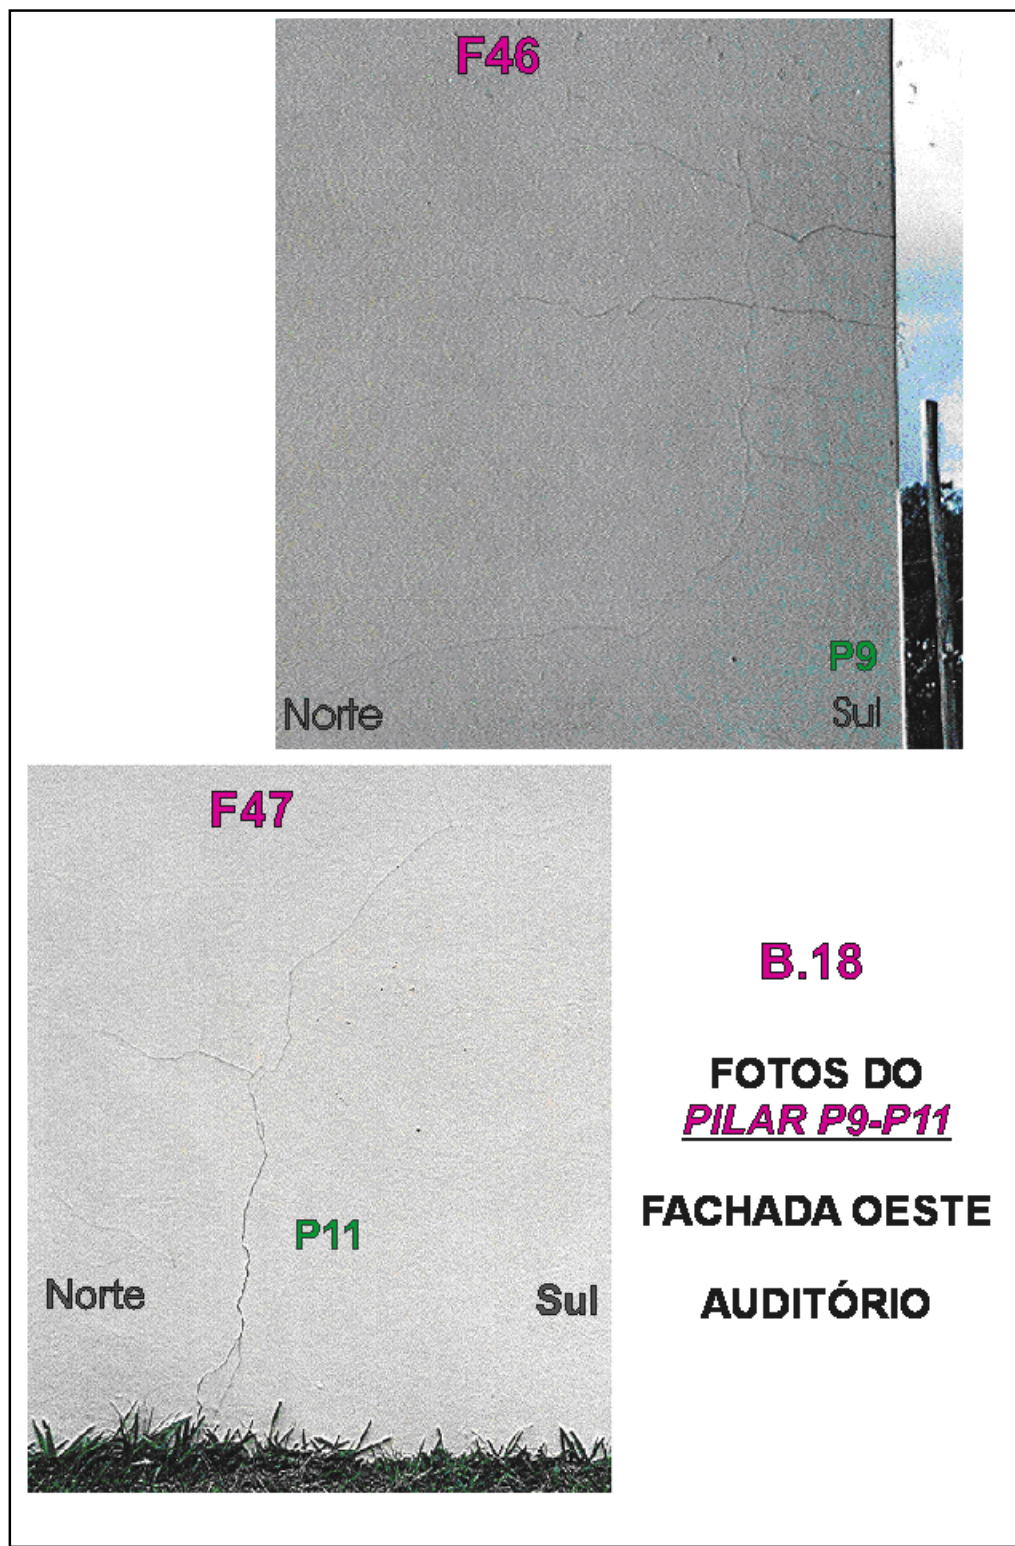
Fotos de fissuras manifestando-se nos pilares P9 e P11, fachada oeste do auditório (ISAIA, 2001, p. 61)
